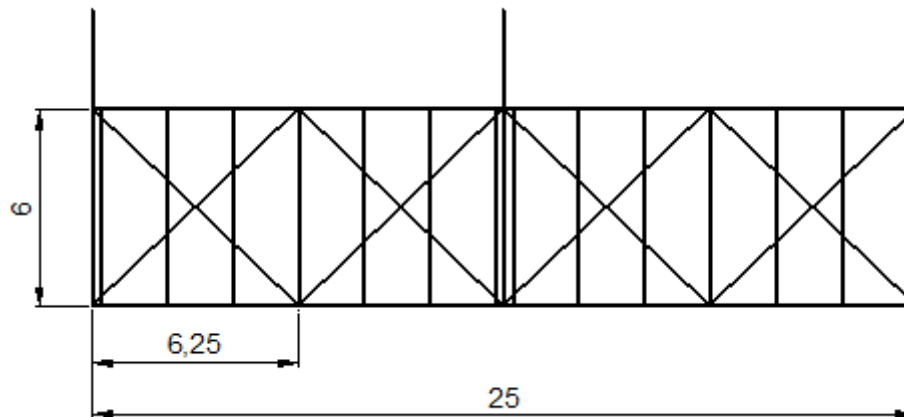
Planta de la distribució de creus de Sant Andreu en coberta.
